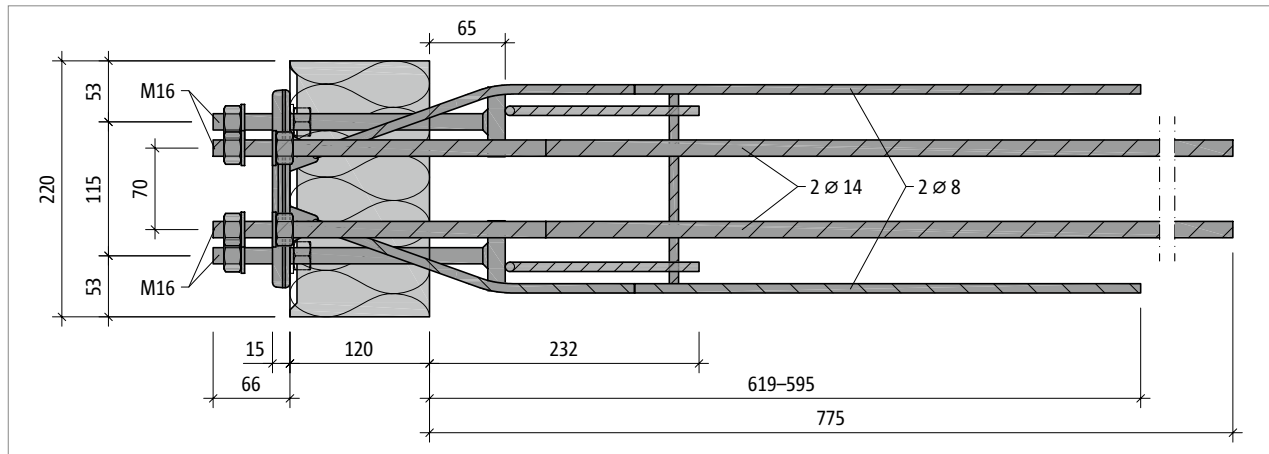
Schöck Isokorb® XT type SK-M1-V1 : vue en plan
